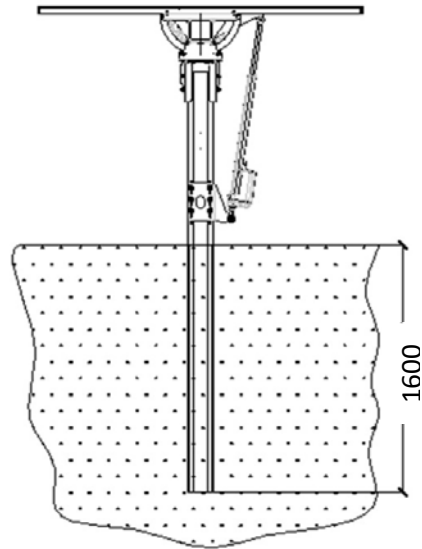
TIPO E LUNGHEZZA DI INFISSIONE
